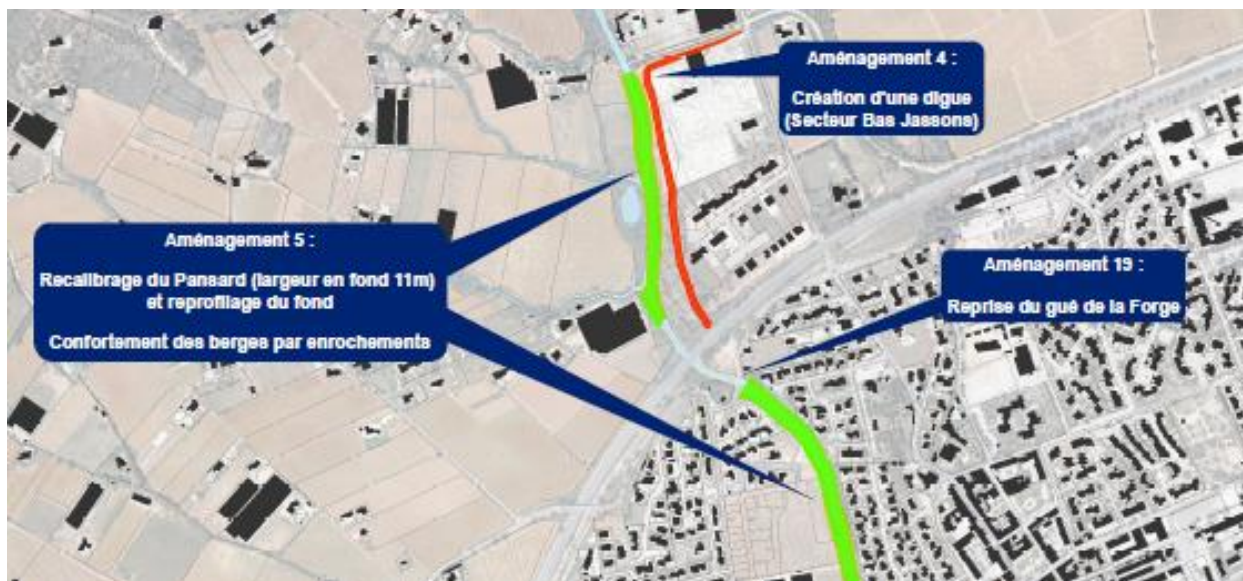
Plan d'aménagement – Quartier Bas Jasson et de la forge (3/5)
